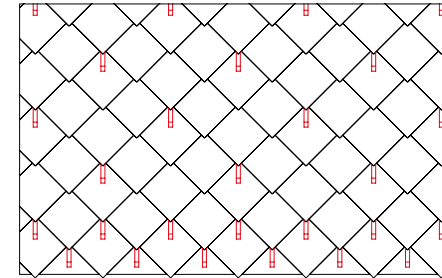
• Verlegeschemen mit dem Schneestopper für die Dachraute 29 × 29
